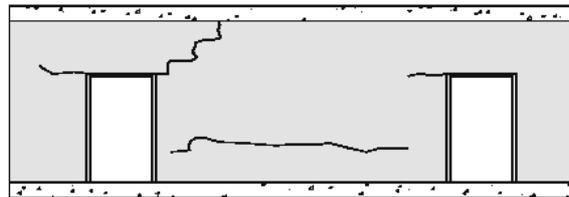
Fissuras em parede com aberturas, causadas pela deformação dos componentes estruturais
